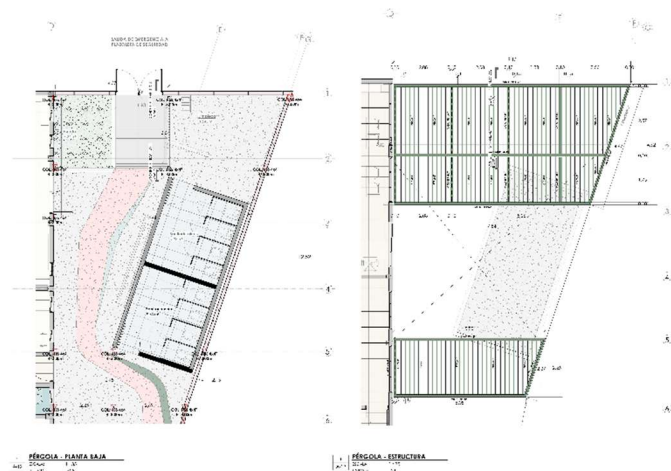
Planta estructural cubierta patio. Elaboración propia.
